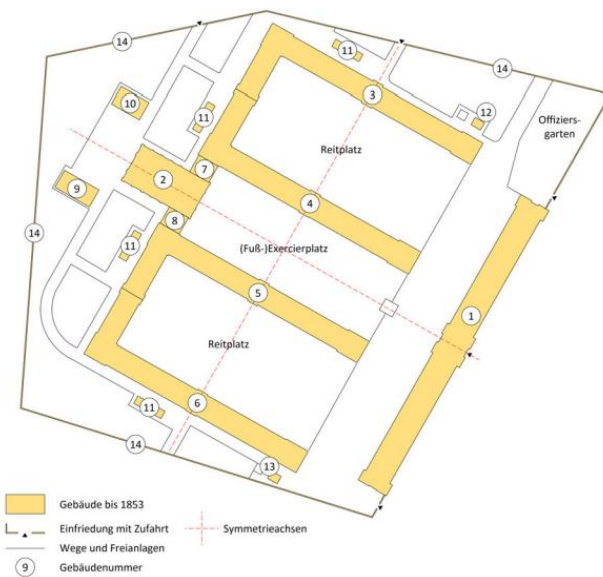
Lageplan der bauzeitlichen Anlage mit Darstellung der Freianlagen aus einem Situationsplan von 1886 (BSQB/SDARC, Studie zum baukulturellen Erbe)
